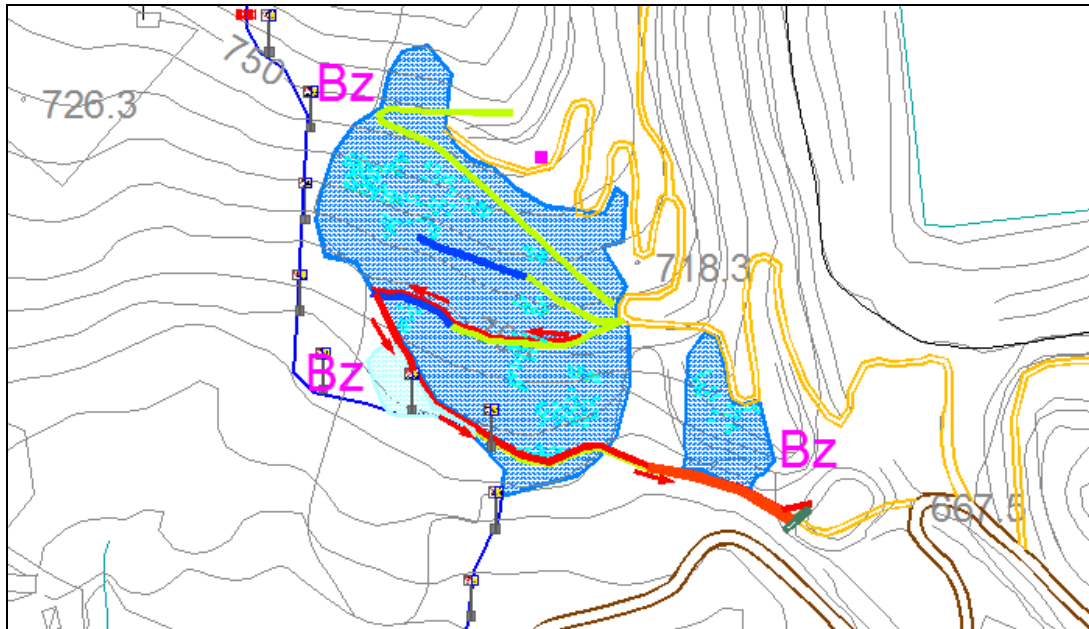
Unità progettuale Bz (cfr. elaborato C2 - Planimetria generale di progetto)
